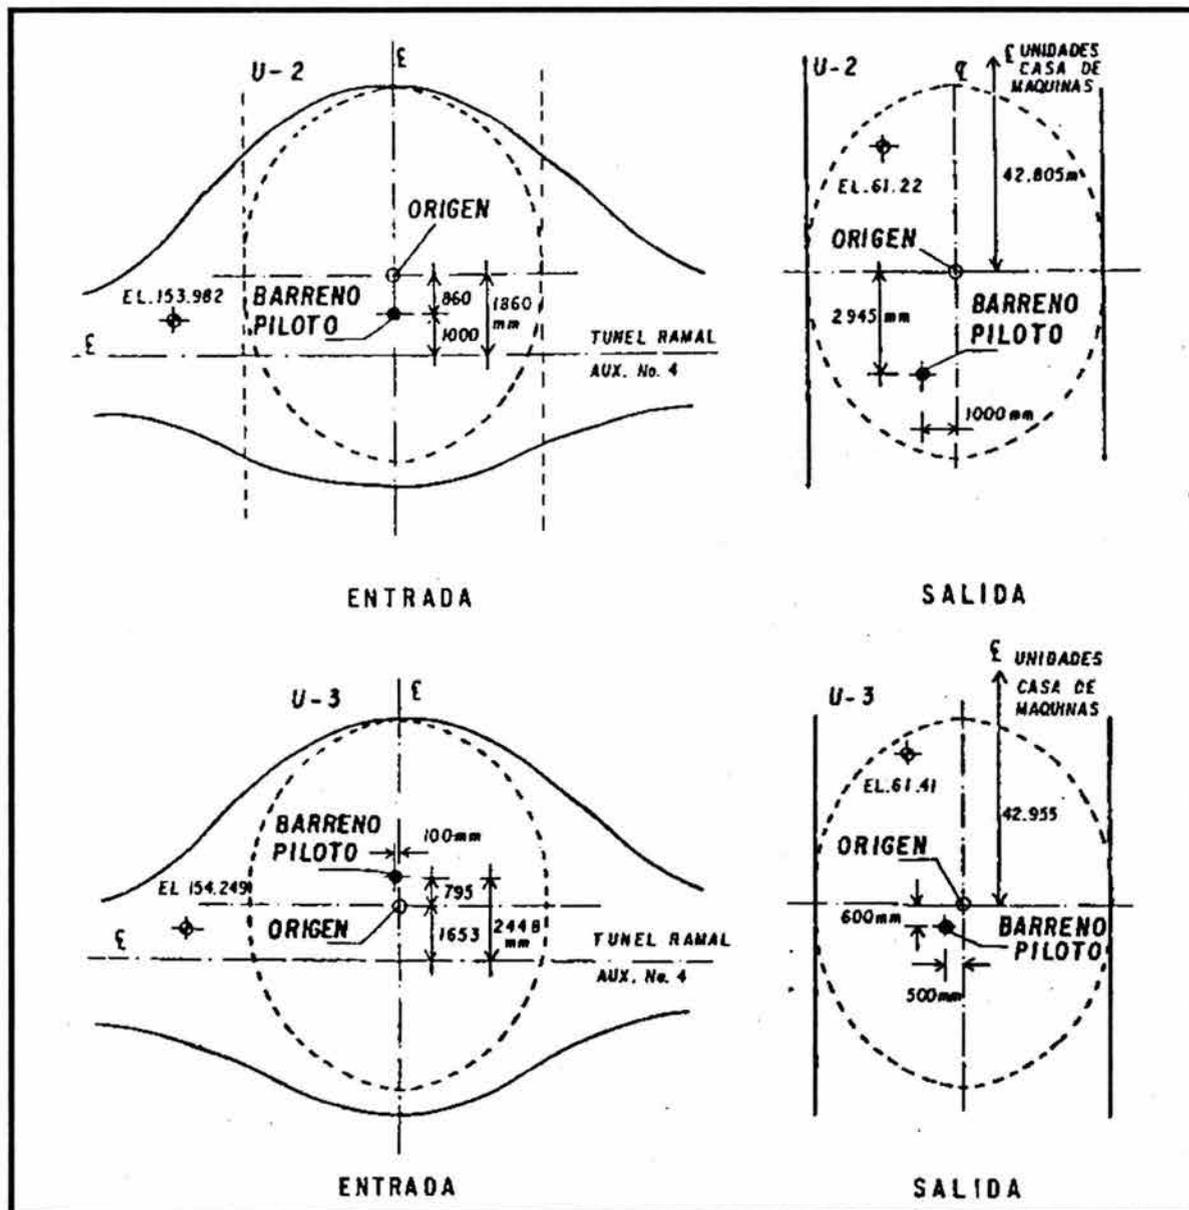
UBICACIÓN DEL BARRENO PILOTO
